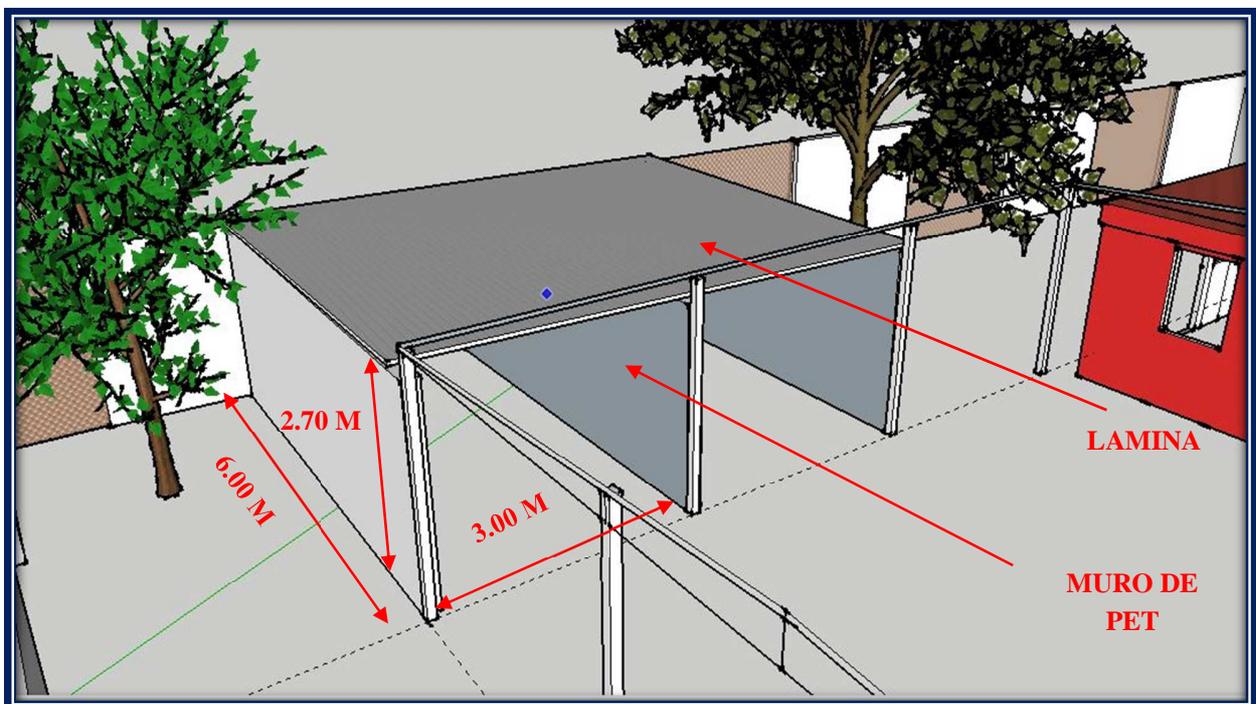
Proyecto a ejecutar. Fuente Archivo Personal.
